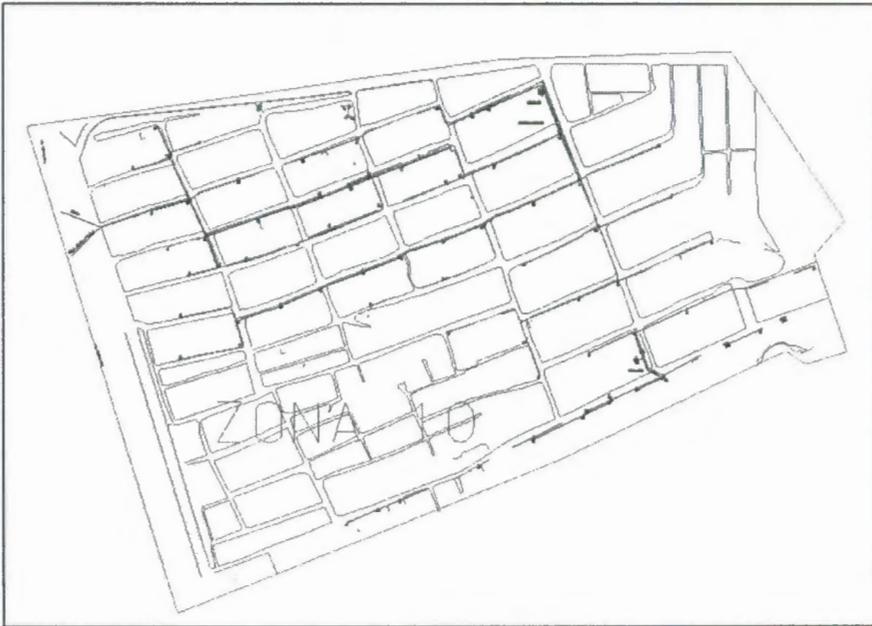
Planimetría zona 10 del sector de la vía a Daule
